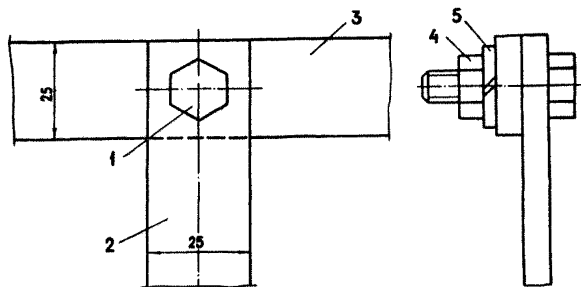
Схема присоединения заземляющего проводника из полосовой стали к заземляющему контуру или сборной заземляющей шине:
